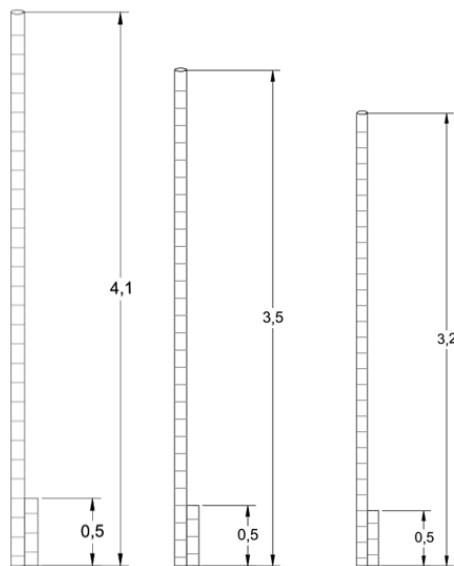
Columnas compuestas sencillas. Fuente: Elaboración Propia
